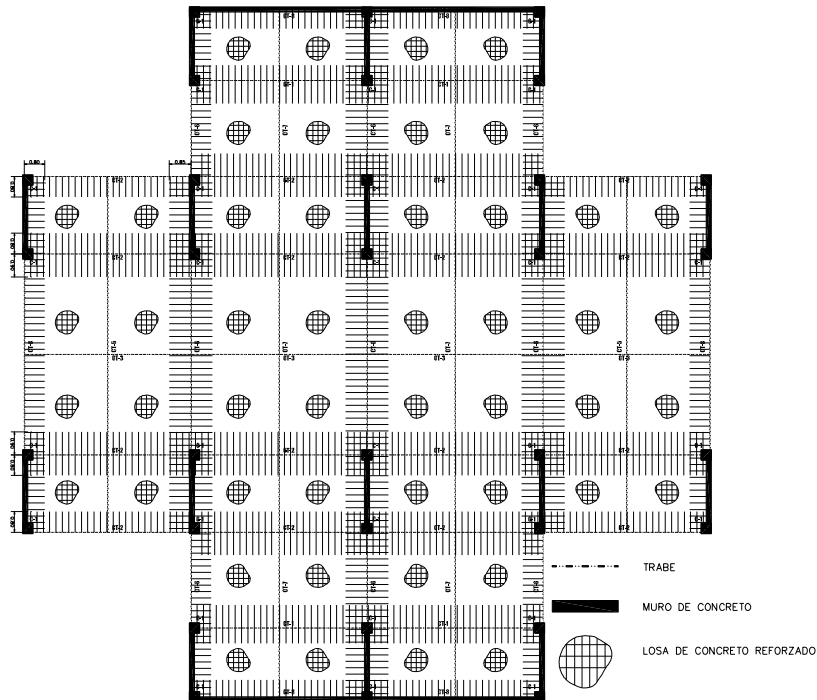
Planta de muros de concreto edificio tipo Cruz
